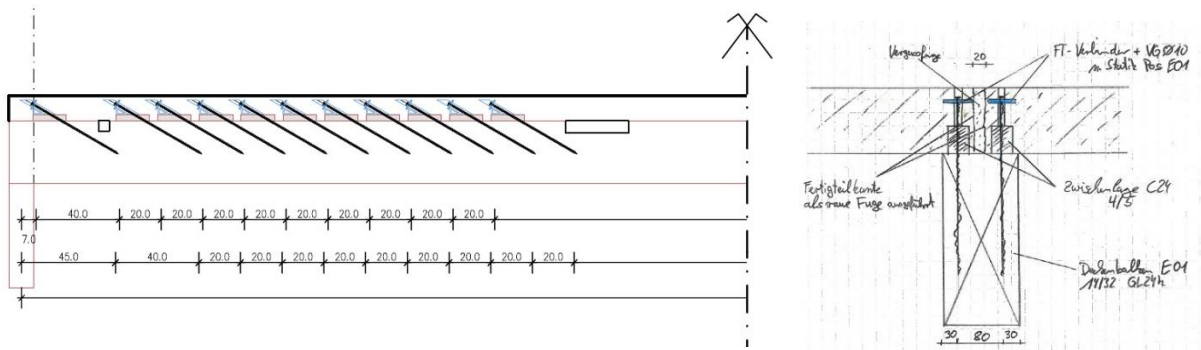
Konstruktionsplan Decke und Schubdetail Deckenstoß
